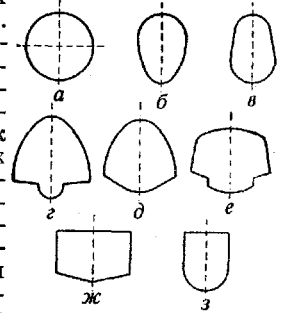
Формы канализационных труб: а—круглая; б и в—яйцевидная (овоидальная); г и е—банкетная; д—лотковая; ж и з—с плоским перекрытием.
